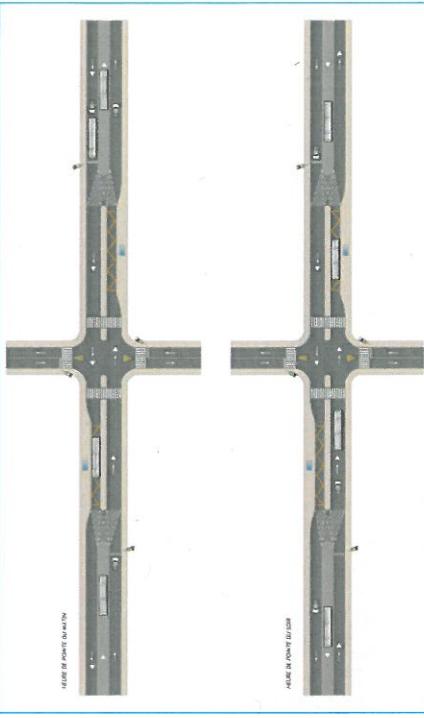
Plan type d'aménagement d'un arrêt en site propre axial
